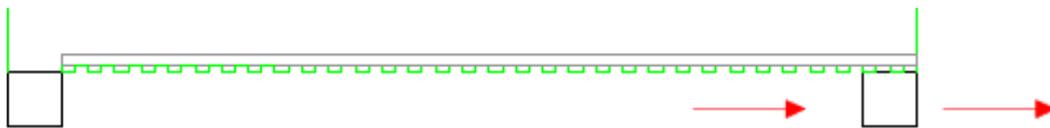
Vista en planta de la puerta corrediza de garaje, en posición cerrada.
